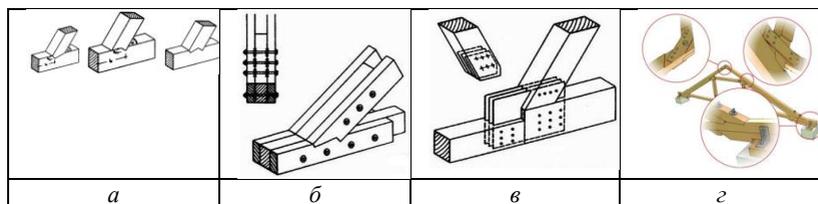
Виды врубок деревянных ферм: *a* – простая одинарная; *б* – двойная с накладками; *в* – с использованием монтажных пластин; *г* – узловые соединения деревянных ферм.
